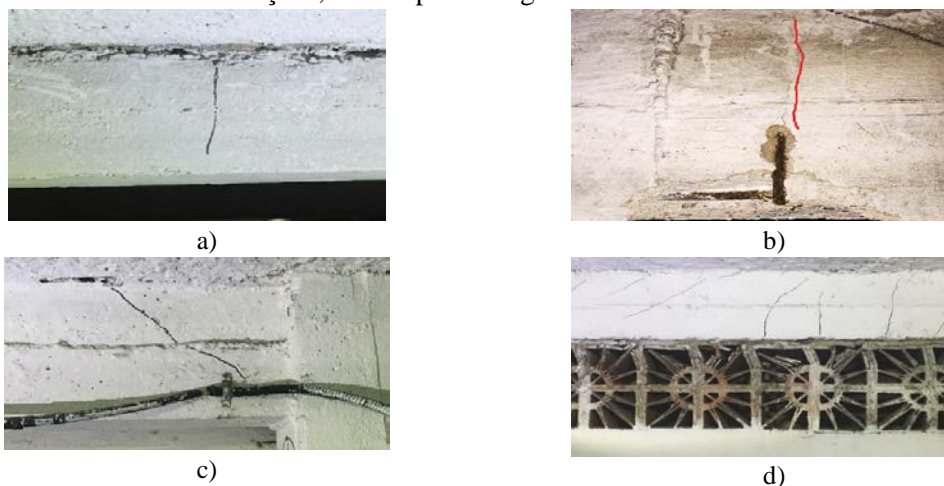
Patologia nas vigas; a) Fissuras de flexão; b) Fissuras devido à corrosão das armaduras de cisalhamento; c) Fissuras de cisalhamento; d) Fissuras devido ao recalque diferencial nas fundações.
